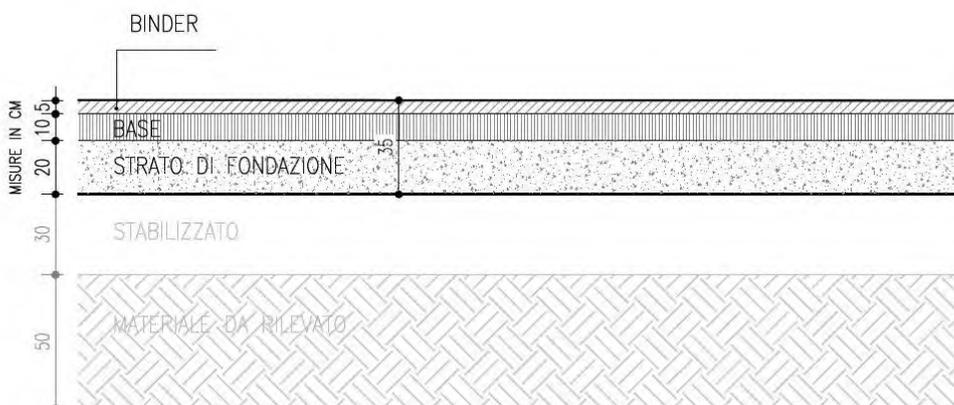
Esempio di pavimentazione di cantiere ripristinata.
